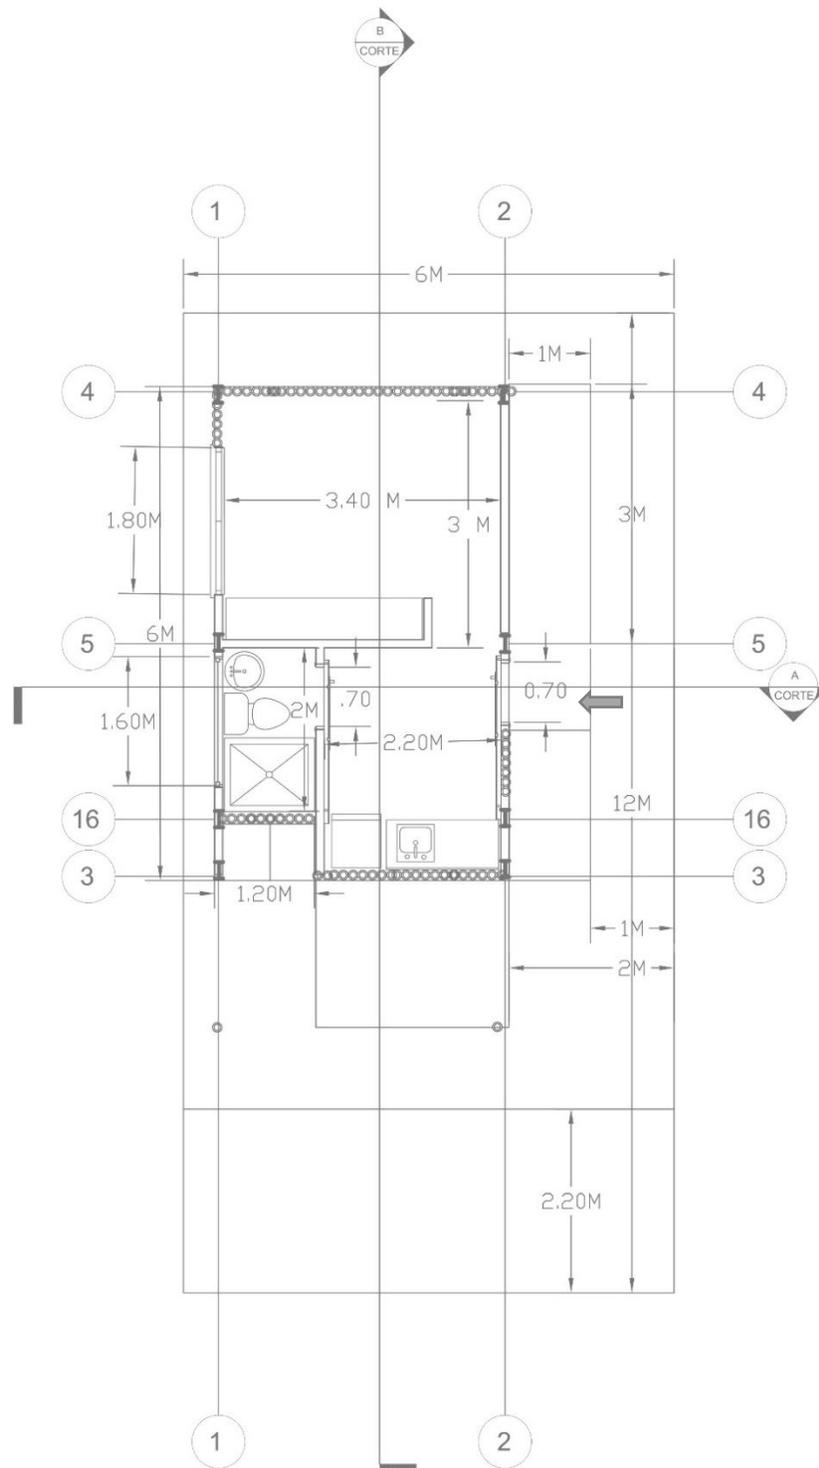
Planta Arquitectónica Prototipo unidad básica
